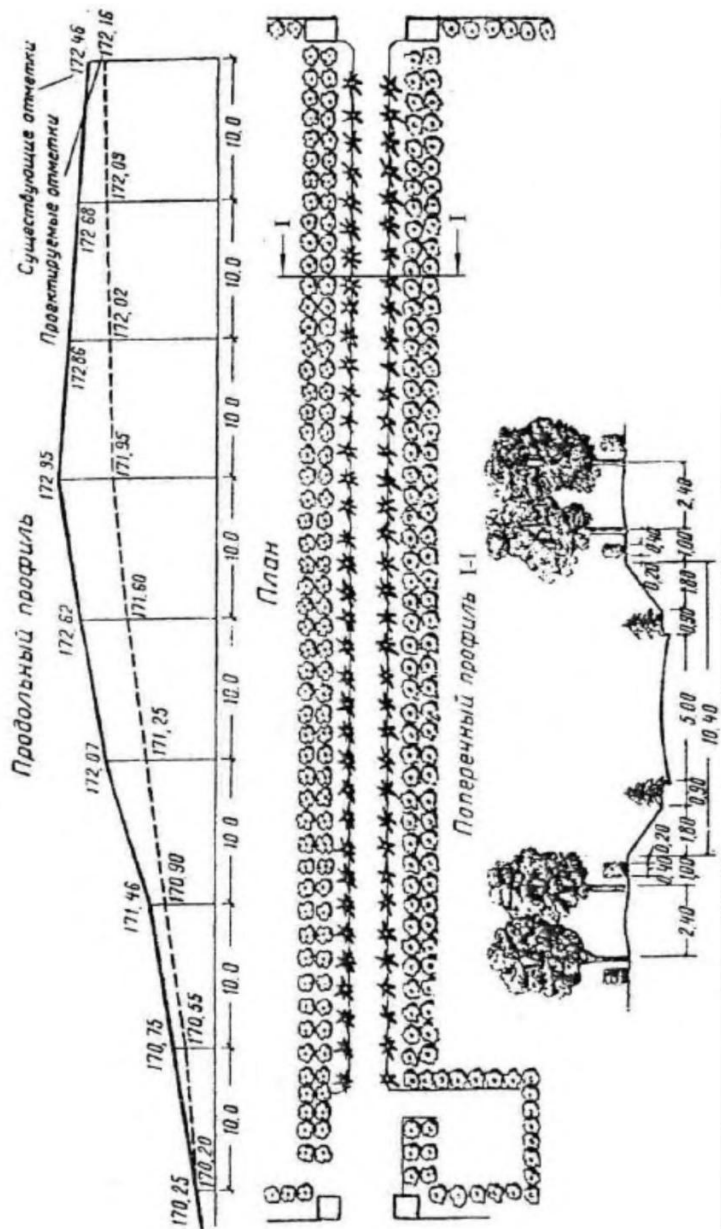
Пример построения продольного профиля участка бульвара: продольный профиль строится сечением через каждые 10 м. Приводится планировка бульвара и поперечный разрез (по материалам Л.Б. Лунца)
